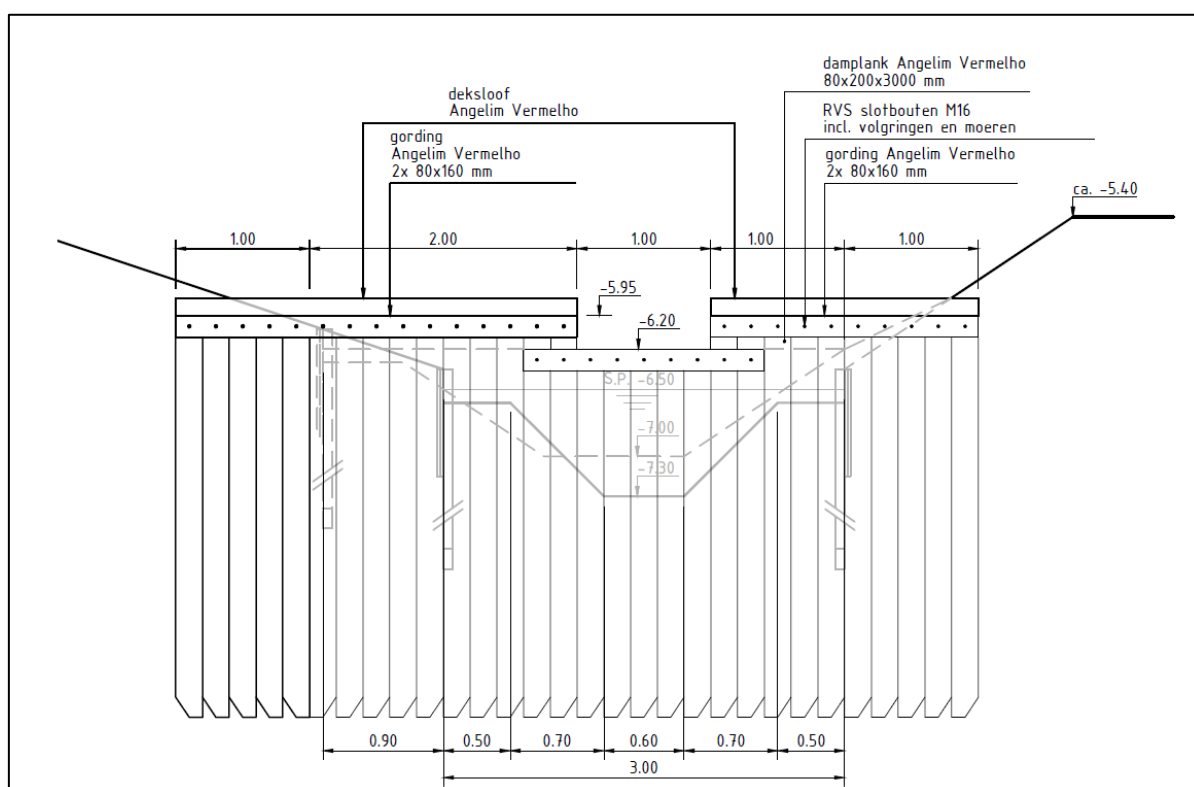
Vooraanzicht uitstroomopening ter plaatse van U1 t/m U3
